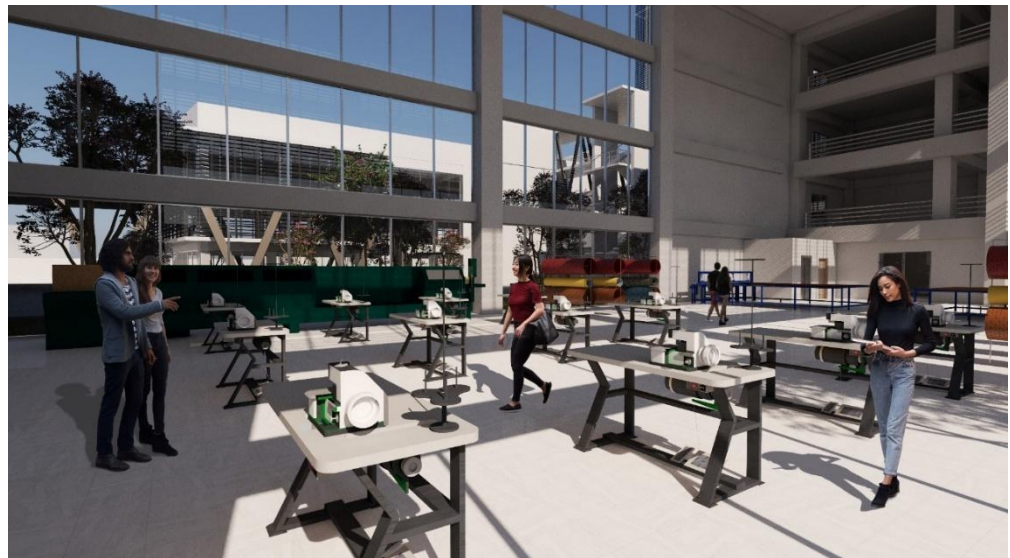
Vista 2 de planta piloto. Fuente: Elaboración propia.
